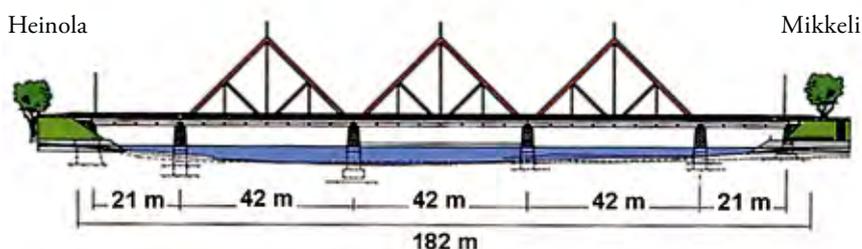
coupe longitudinale du pont de Vihantasalmi
